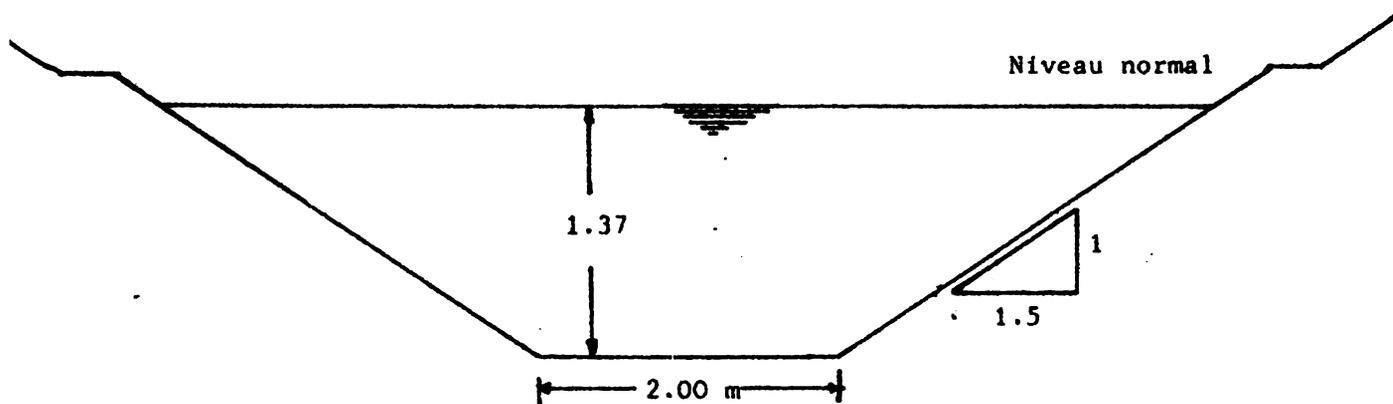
Schéma de la section transversale d'un canal trapézoïdal.
